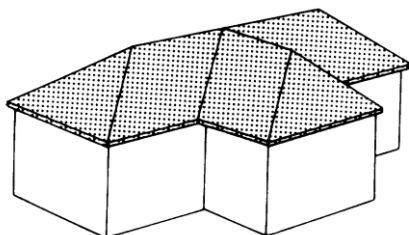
Вальмовая крыша с разжелобками (Stanley Tools)
